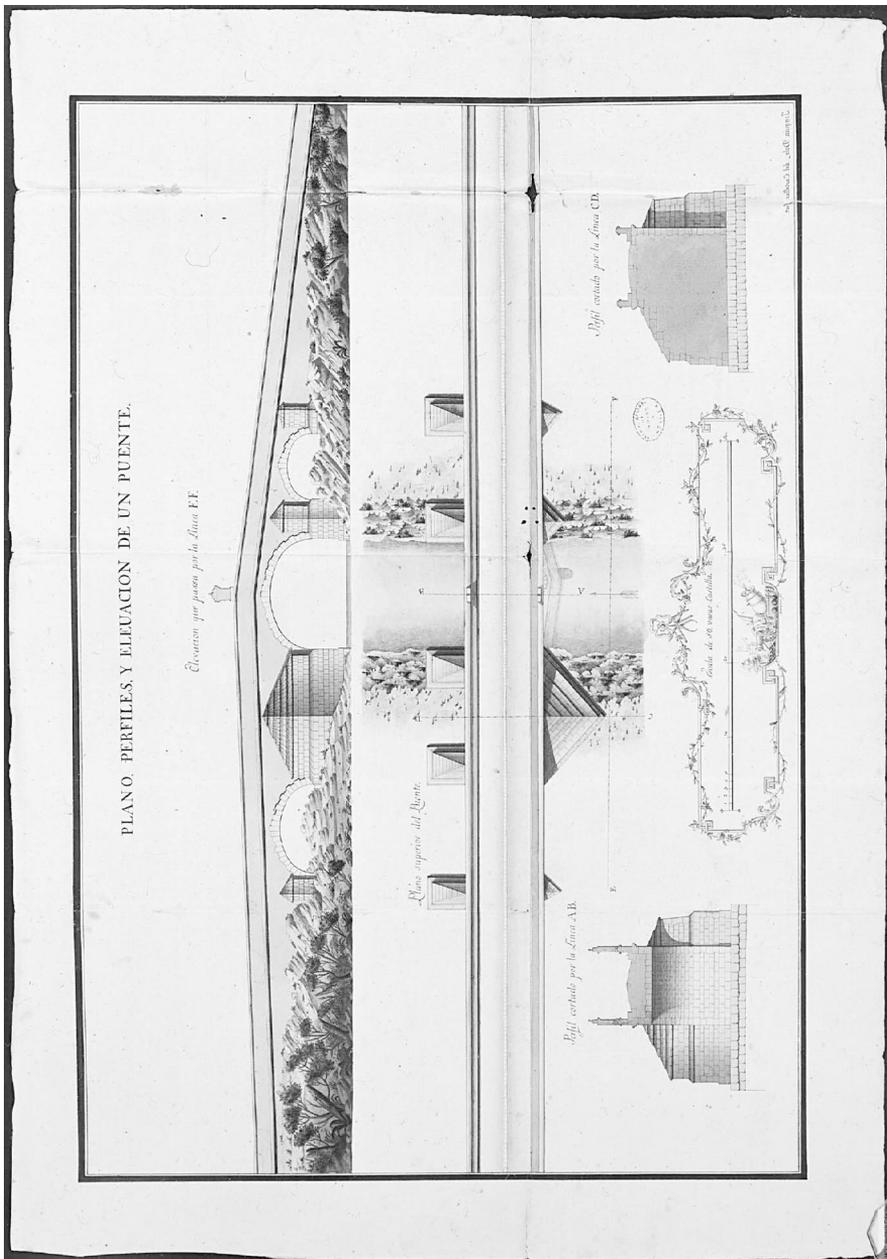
Plano, perfiles y elevación de un puente sobre el río Cojímar. AGI, Santo Domingo, nº 562.
